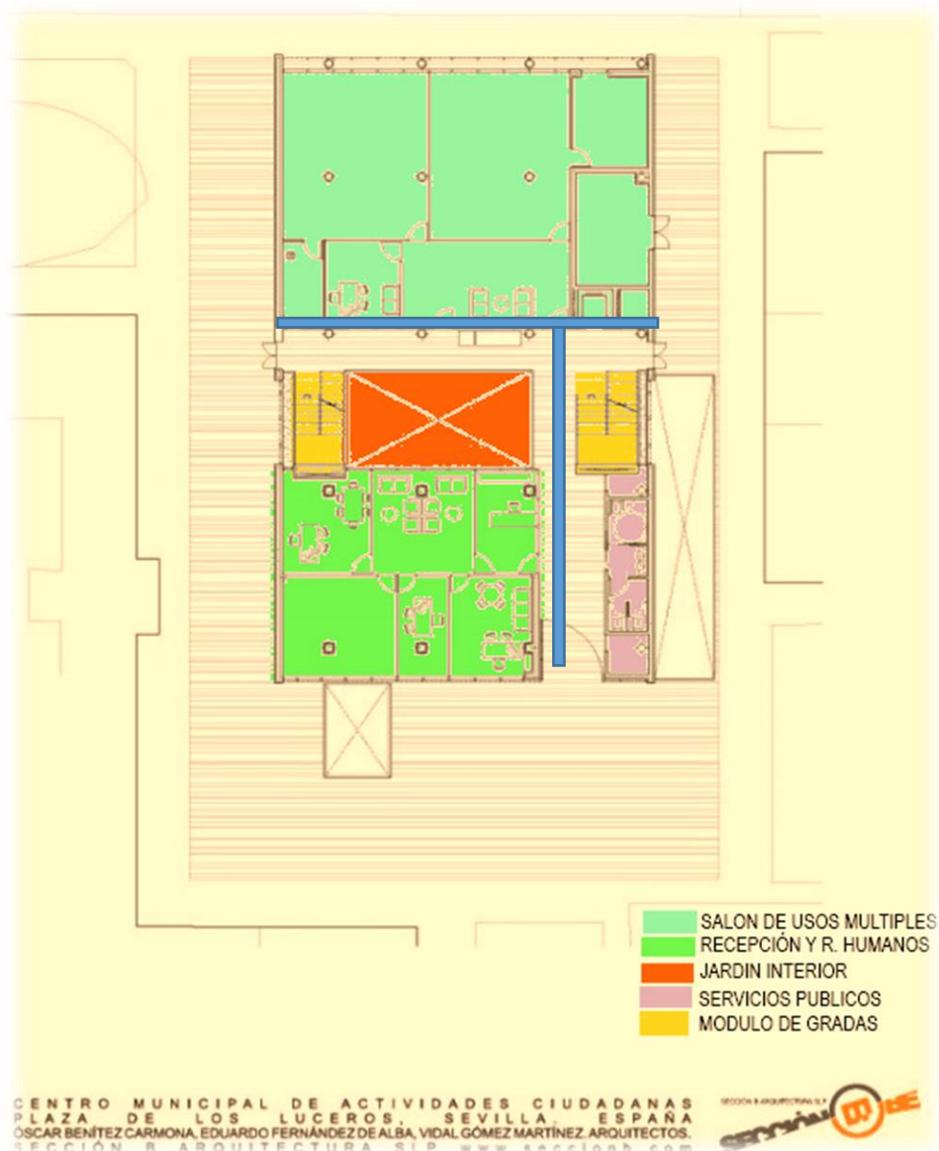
Planta de ubicación y planta baja del Edificio municipal.
